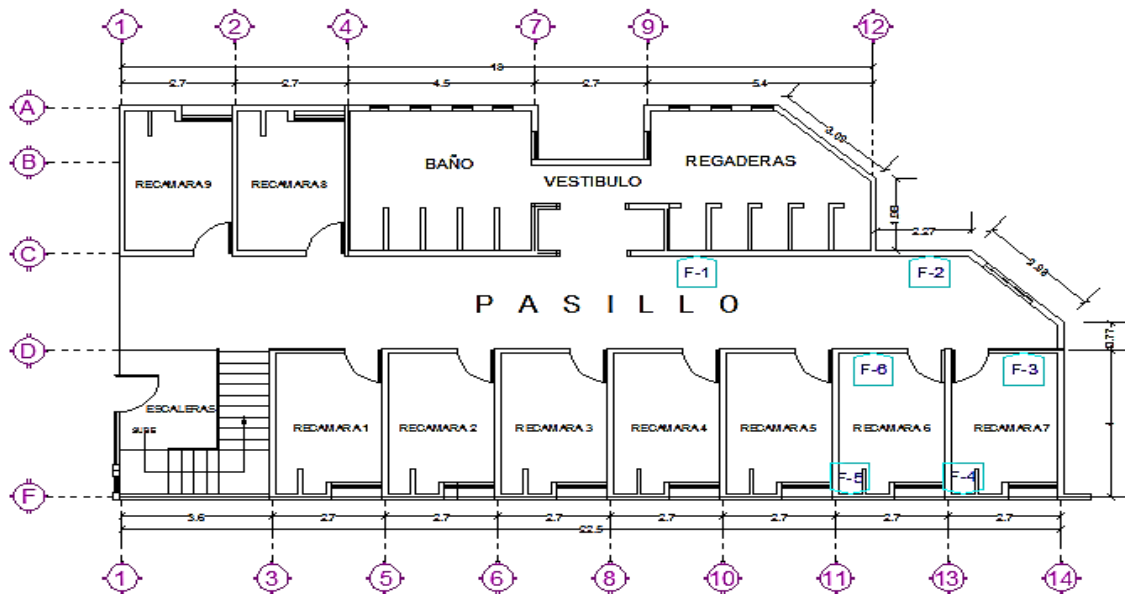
Localización de los Fisurómetros en la Planta Baja
